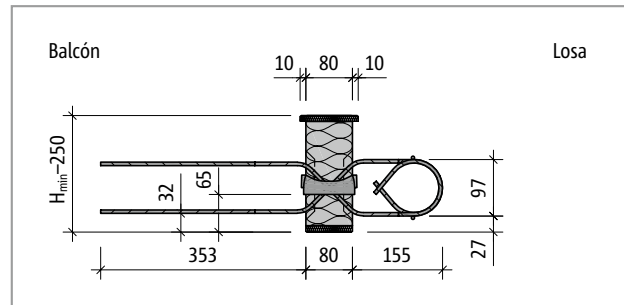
Schöck Isokorb® T tipo Q-VV1 hasta Q-VV5: Sección del producto
